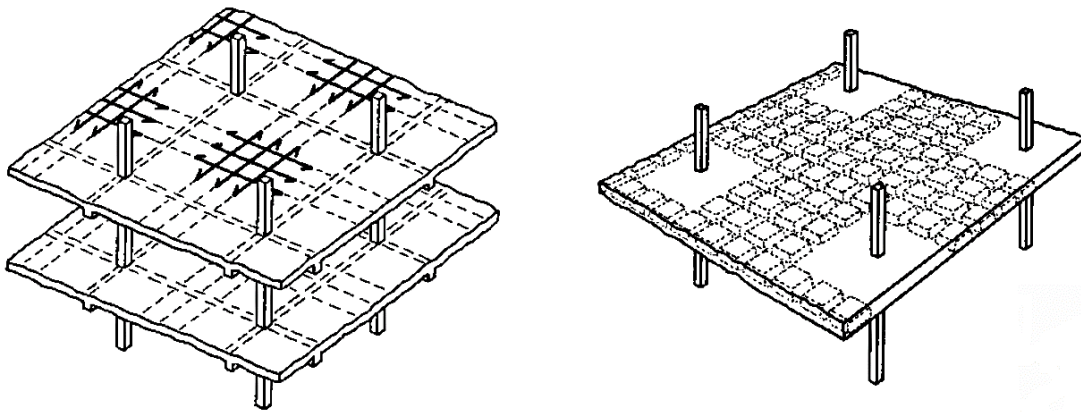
Tipologías de los forjados de hormigón armado
